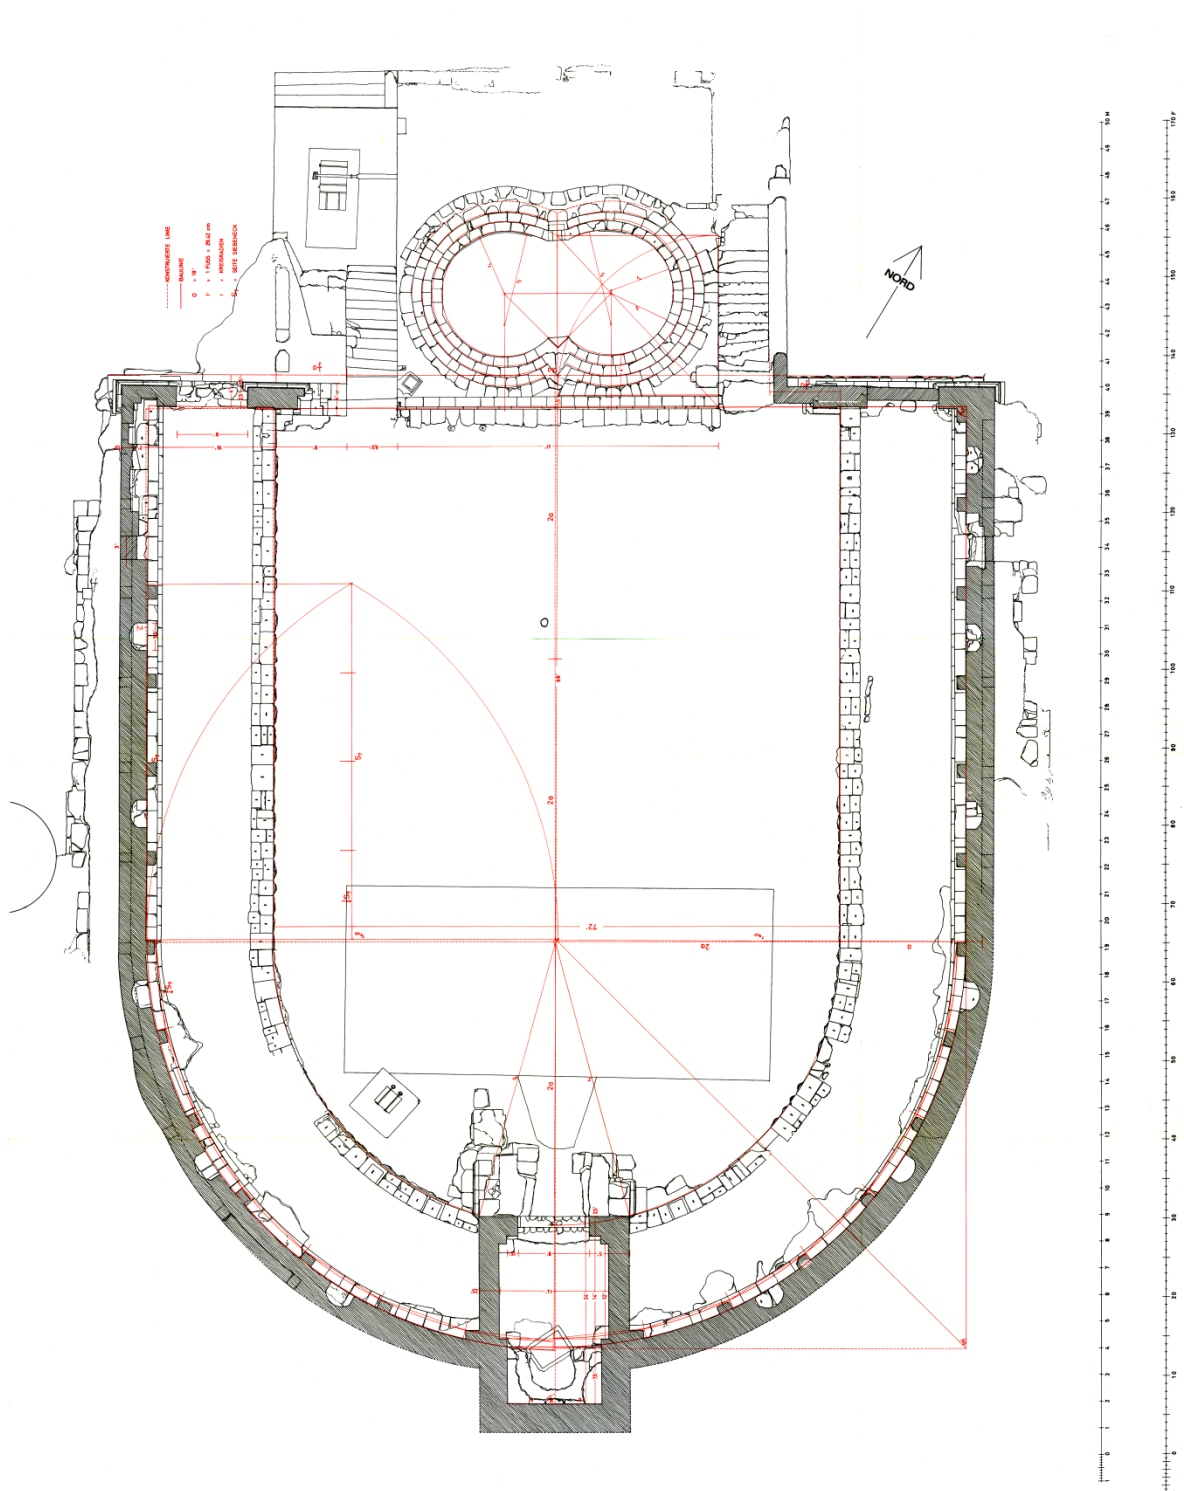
Quellheiligtum Zaghuan – Grundriss
